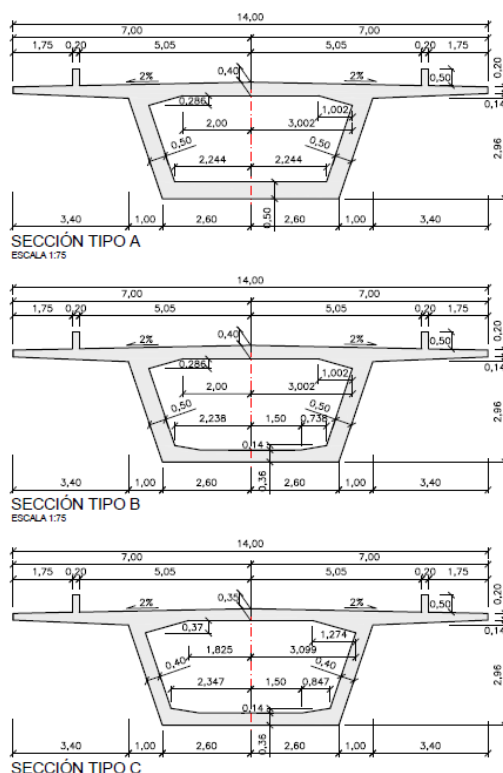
Secciones transversales del tablero a lo largo del viaducto
